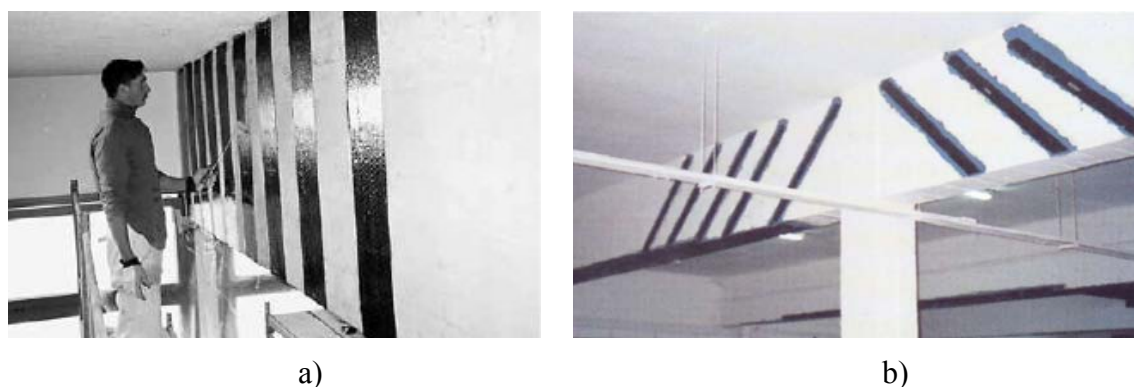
Exemplos de reforço ao corte de vigas com sistemas de CFRP (S&P).
